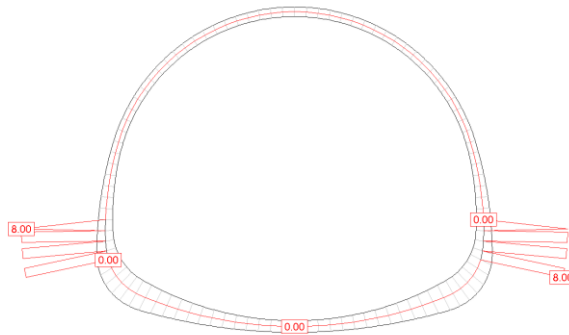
Túnel do Cais. Armadura de esforço transverso necessária
